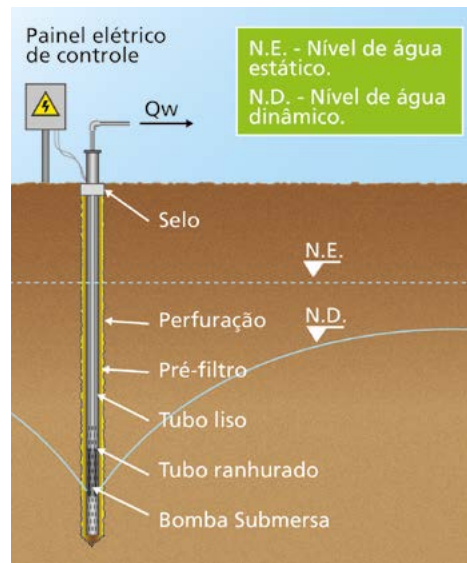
Montagem geral do rebaixamento por poços com bomba submersa
